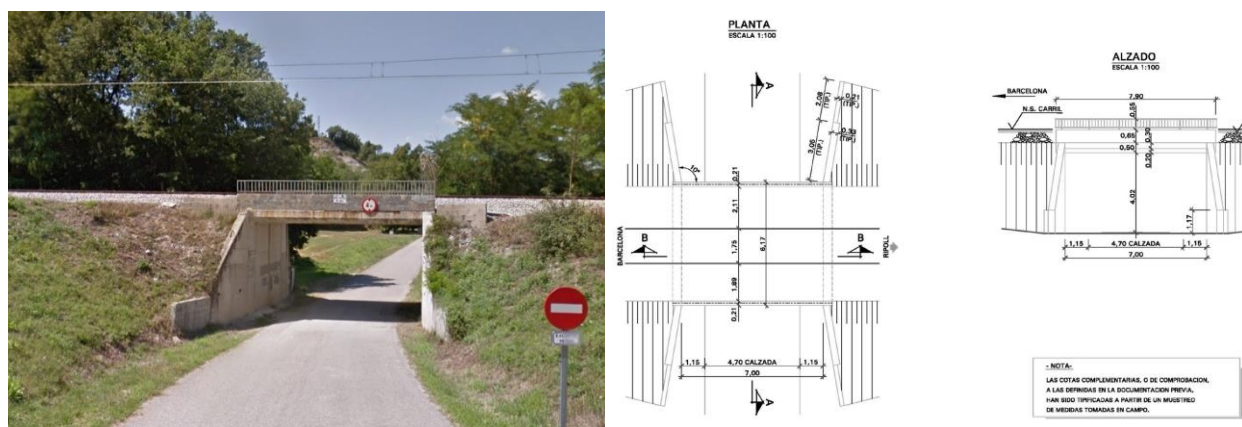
Paso inferior existente en carretera local en el P.K. 59+230. Para la duplicación se contempla el ensanche de la estructura.
